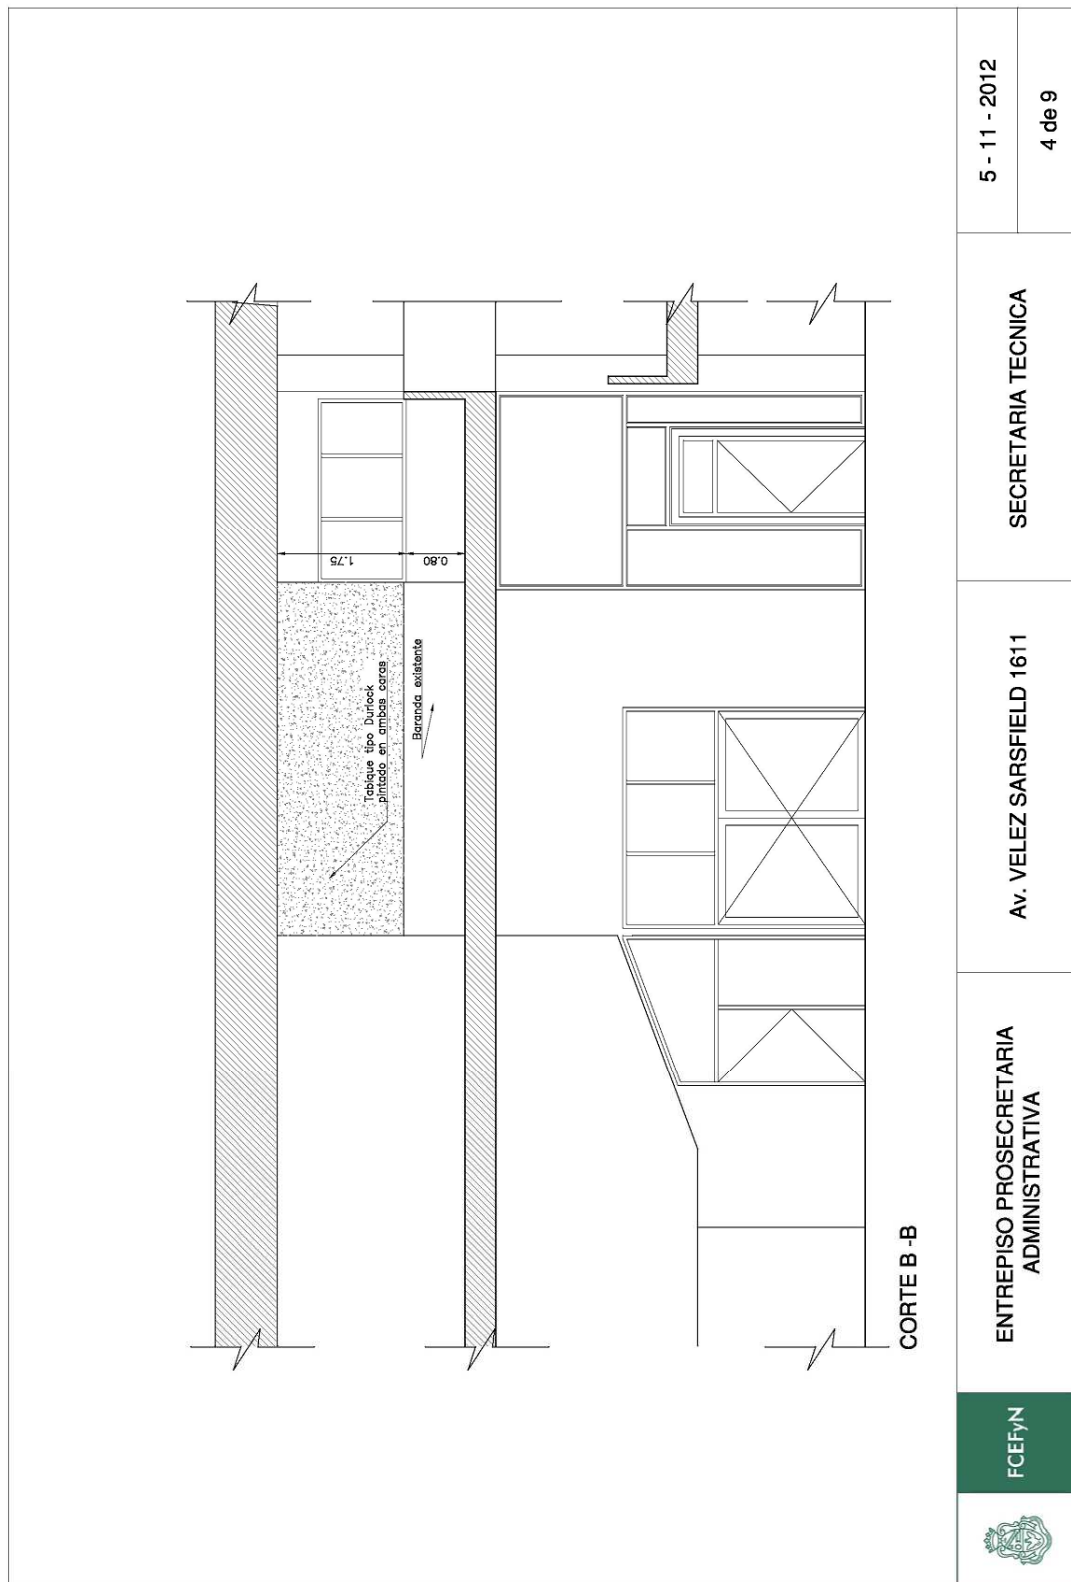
Plano 4 – Fuente: Digitalización de planos originales
